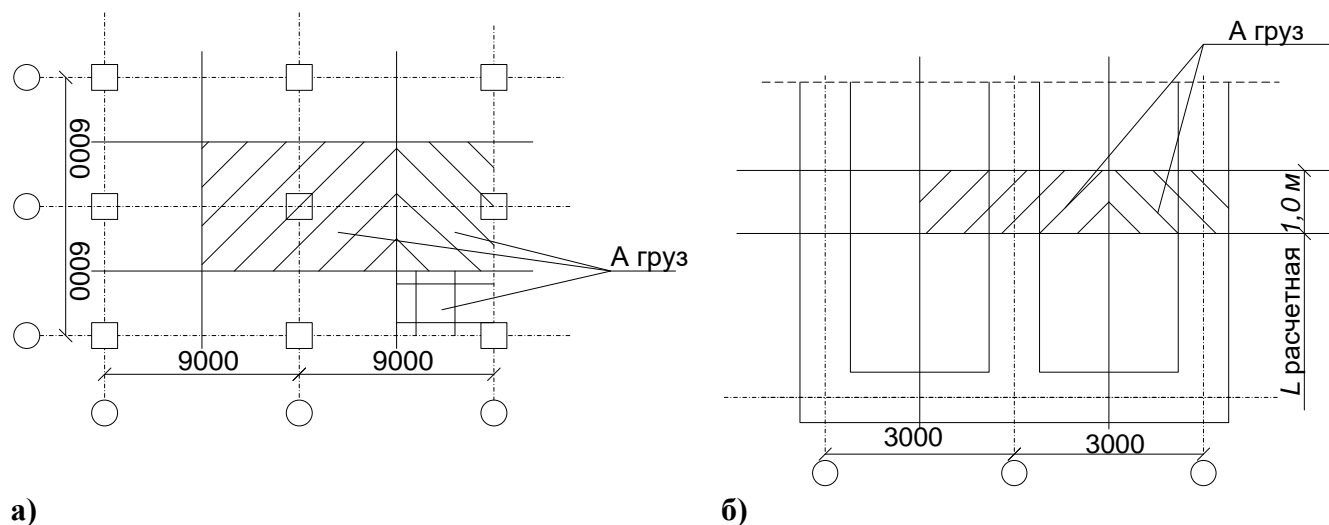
Схемы определения грузовой площади для сбора нагрузок
